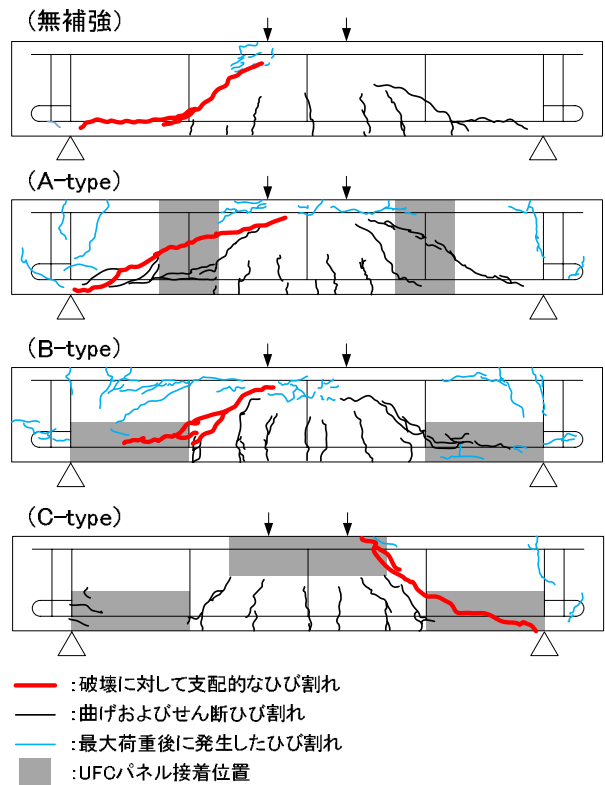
ひび割れ図 (UFC パネル除去後)
